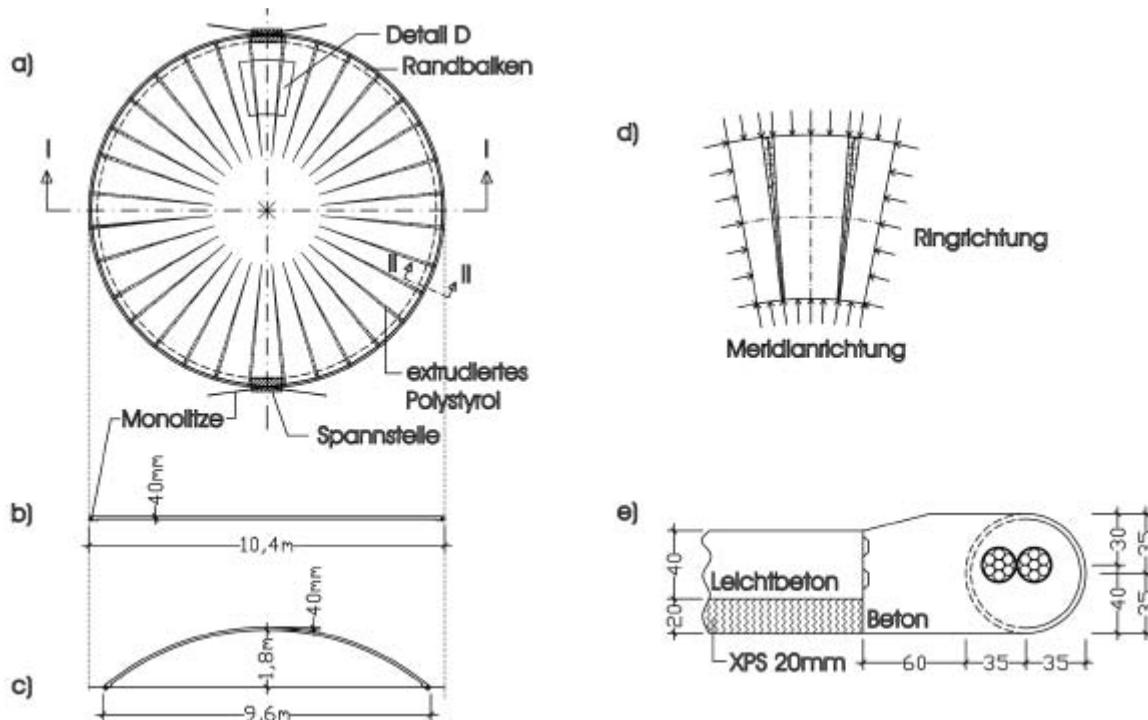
Herstellungsverfahren: a) Stahlbetonplatte im Grundriss, b) Schnitt durch die Platte, c) Schnitt durch die Schale nach dem Anspannen der Spannglieder, d) Spannungen im Ausschnitt D der Platte beim Anspannen der Spannglieder, e) Schnitt durch den Randbalken
